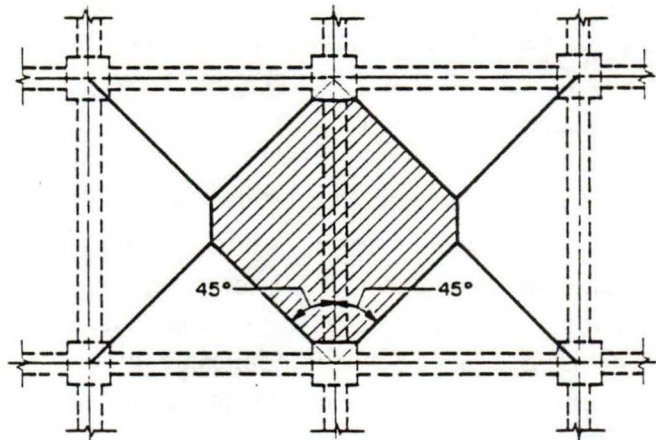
Área tributaria para corte en una viga interior.
